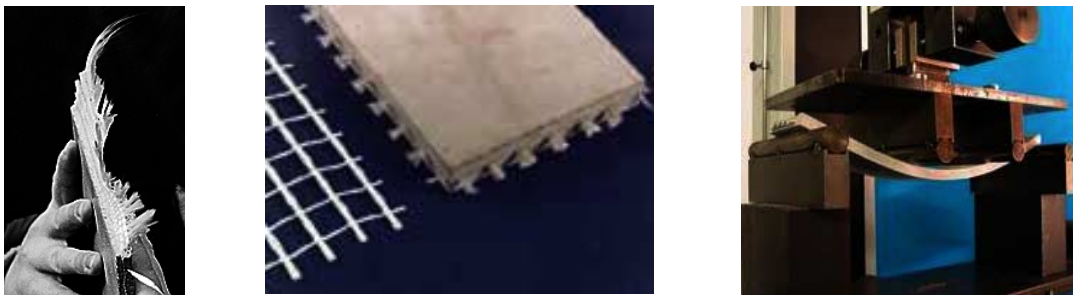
Textilbewehrter Beton in dünnwandigen Bauteilen
